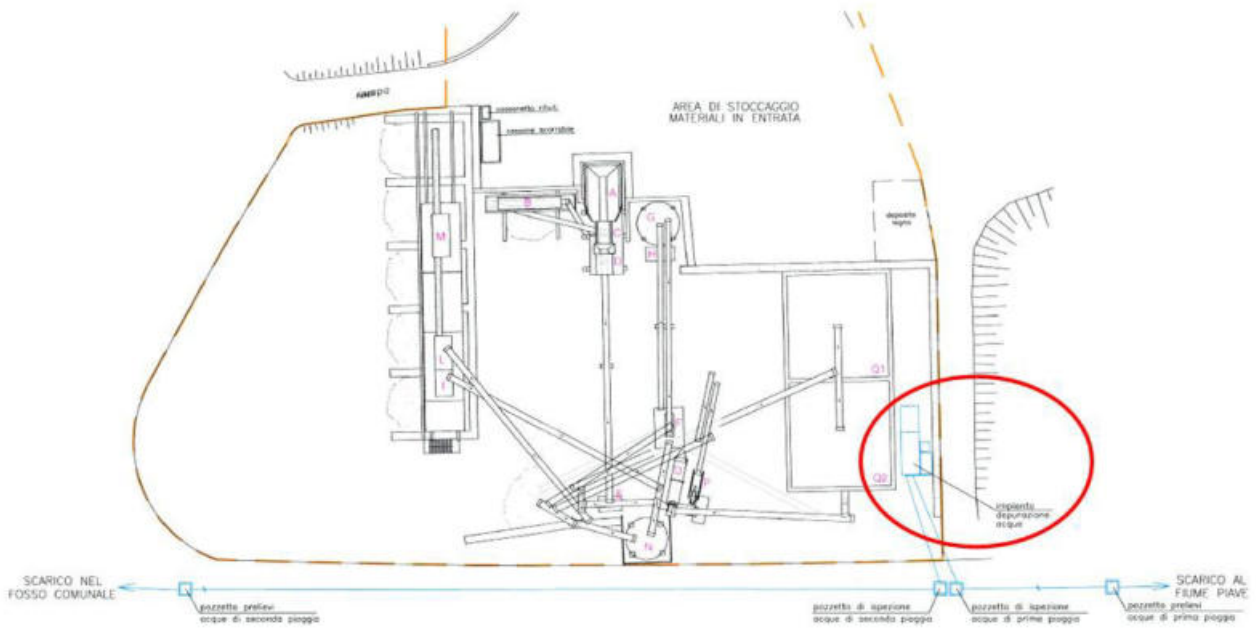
impianto di depurazione esistente come rappresentato in planimetria 2013 Prot. 0036266/2013
